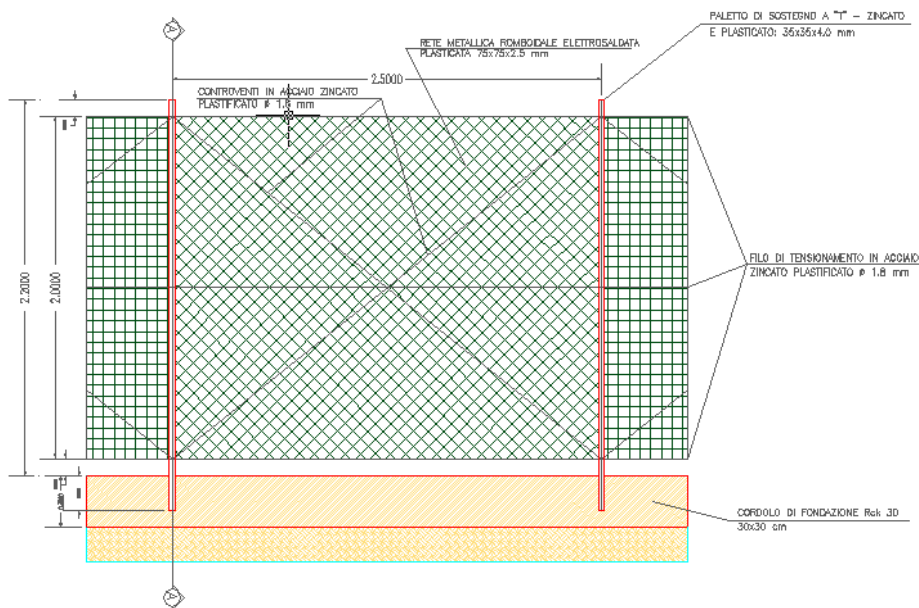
Particolare del sistema di recinzione del sito contaminato.
